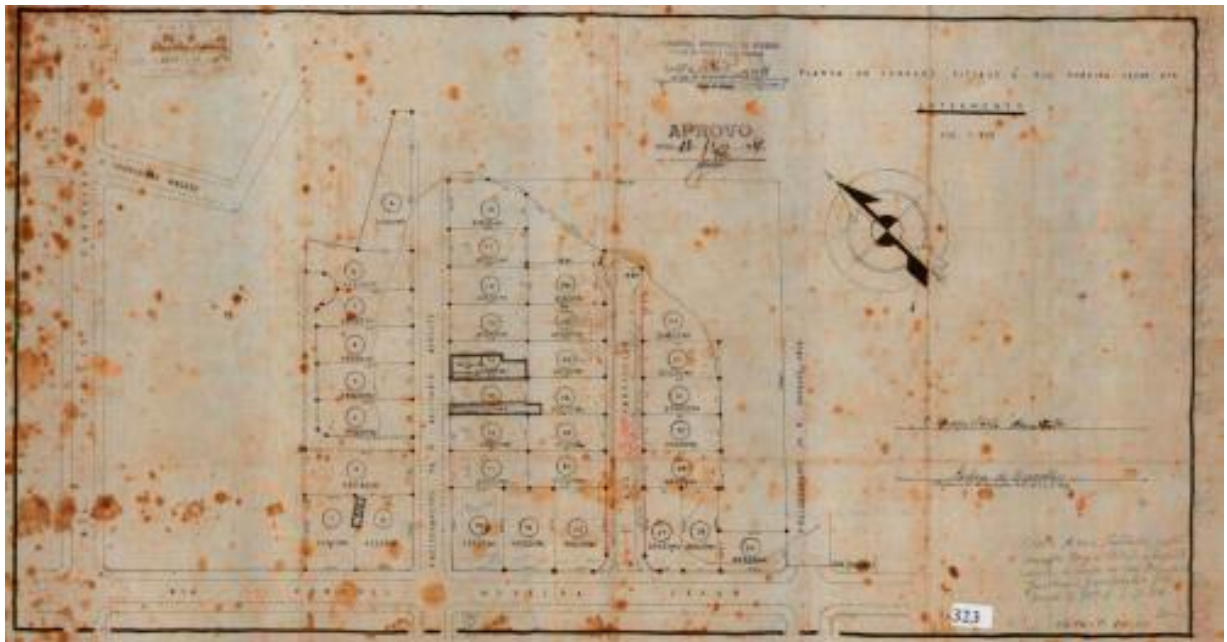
Planta de Arruamento das Ruas Belizário Augusto e Guilherme Greenhalgh.
